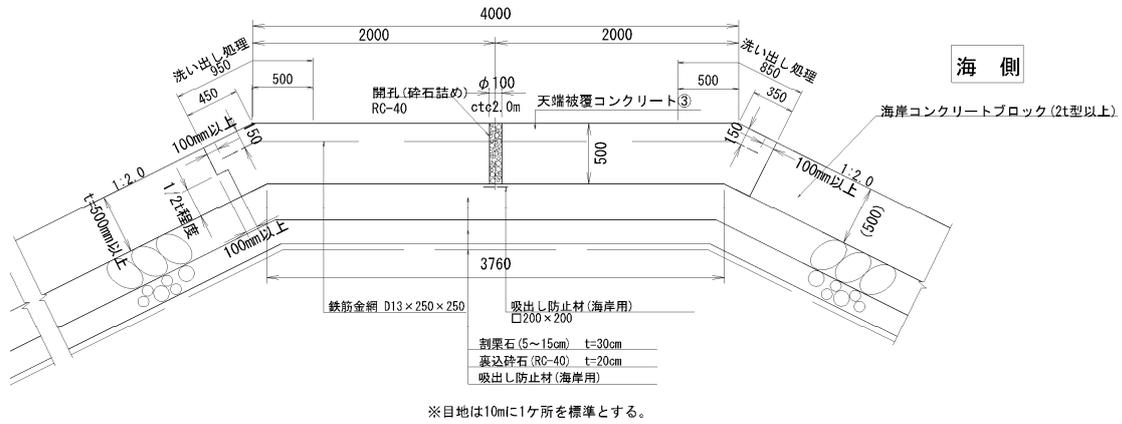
天端被覆コンクリート標準断面 (法肩部含め現場打ち)
